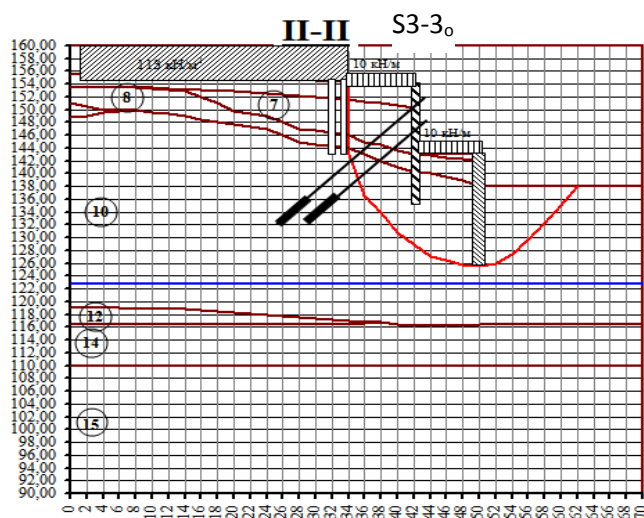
Расчетная схема устойчивости подпорных стен для сечения S3-3₀ с учетом работы анкеров
